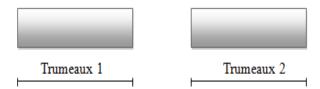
Vue en plan du voile avec un seul fil d'ouverture.
